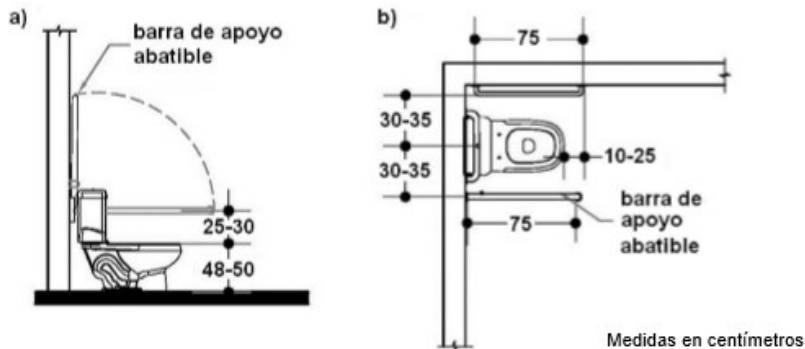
Literal a, vista en elevación lateral y literal b, vista en planta donde se grafican las tres barras de apoyo a ambos lados y en la parte posterior del inodoro con sus medidas
